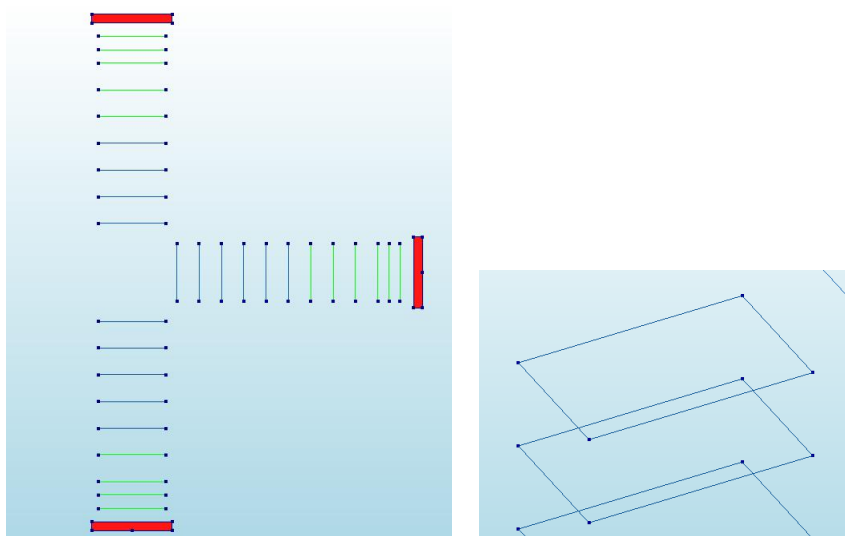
Izq: Distribución refuerzo transversal, Der: Detalle estribos en columna.
